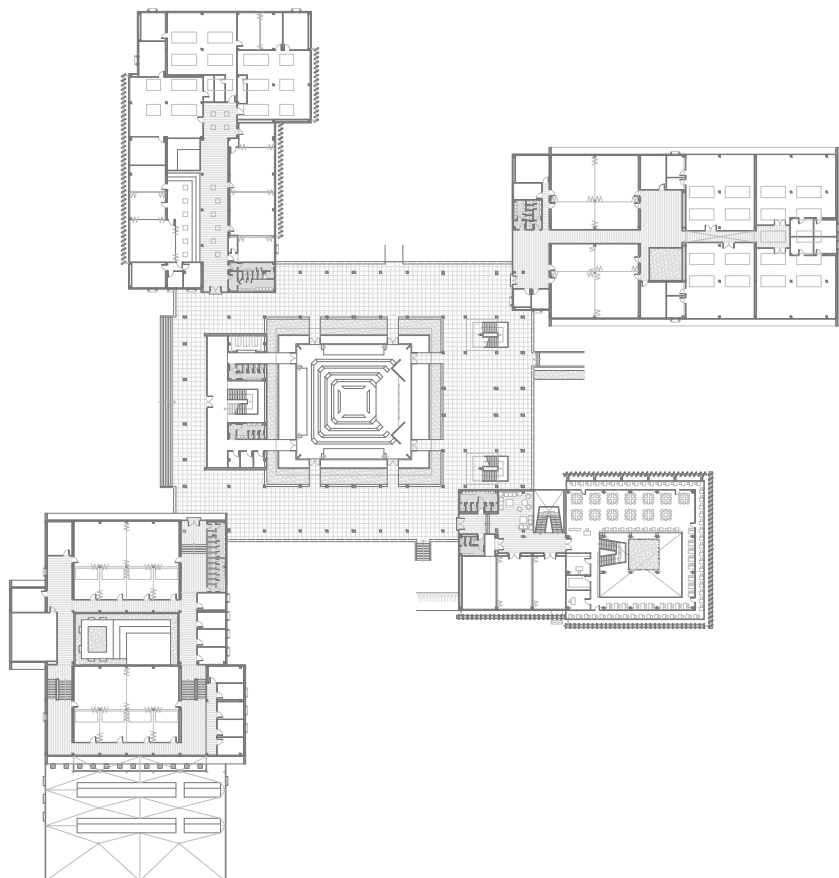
Planta baja de la zona docente: edificio de dirección y pabellones docentes.
